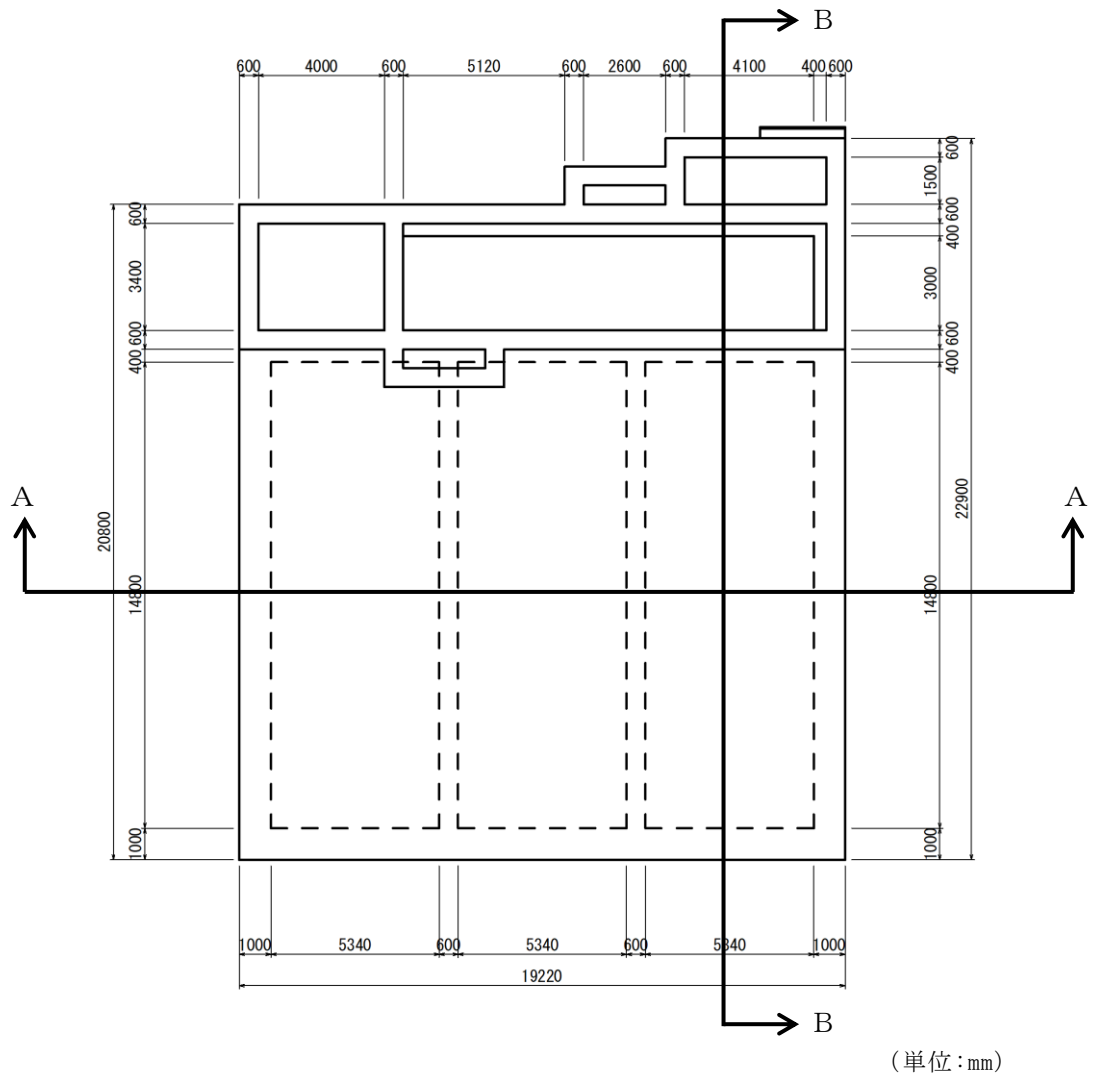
B-ディーゼル燃料貯蔵タンク格納槽 平面図
